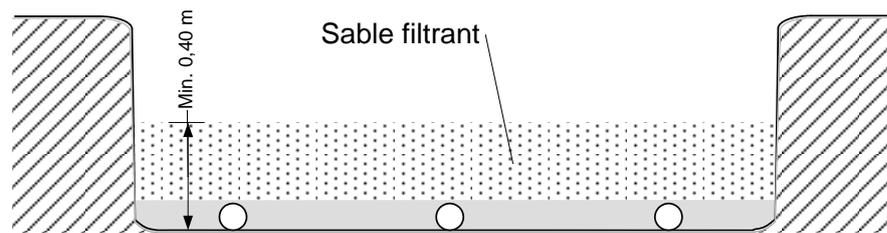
Vue en coupe du bassin avec la couche de sable filtrant
